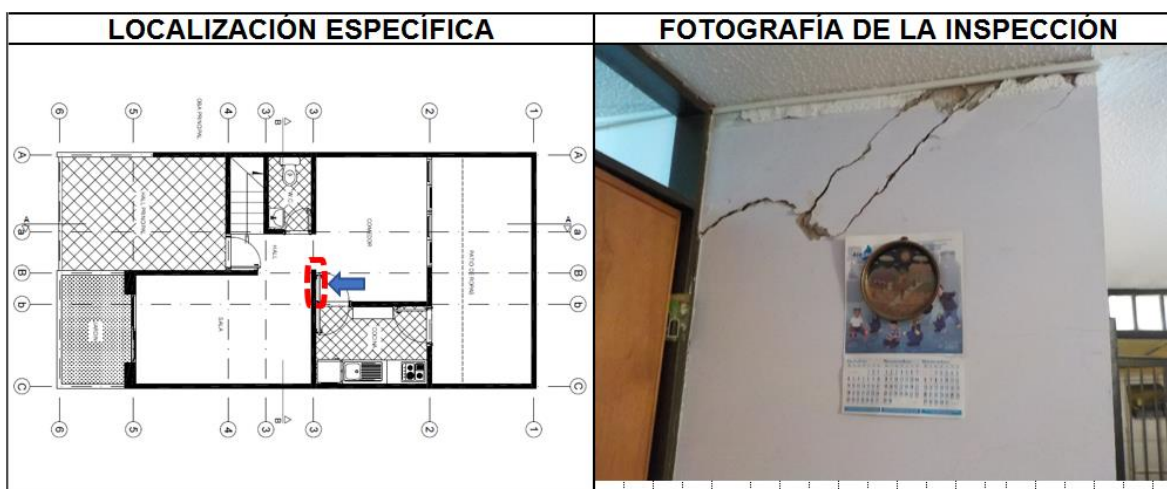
Muro M14, la grieta atraviesa el muro, se observa desprendimientos. Fuente propia 2017.
